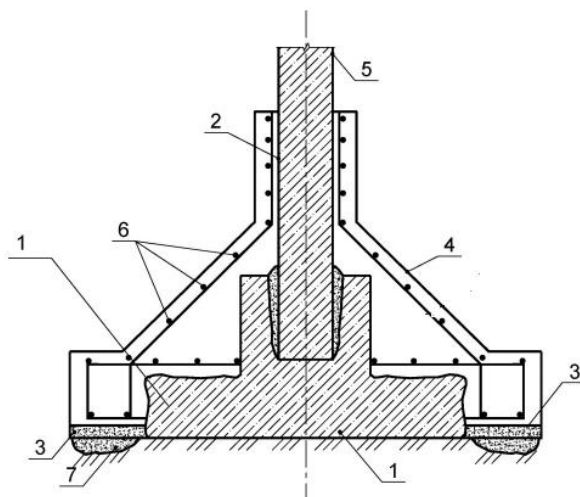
Увеличение несущей способности столбчатого отдельно стоящего фундамента: 1 – усиливаемый фундамент; 2- поверхность колонны с насечкой для обеспечения сопряжения с конструкцией усиления; 3 – бетонная подготовка; 4 – конструкция усиления; 5 – колонна; 6 – арматура конструкции усиления; 7 – уплотненный грунт. [198]
